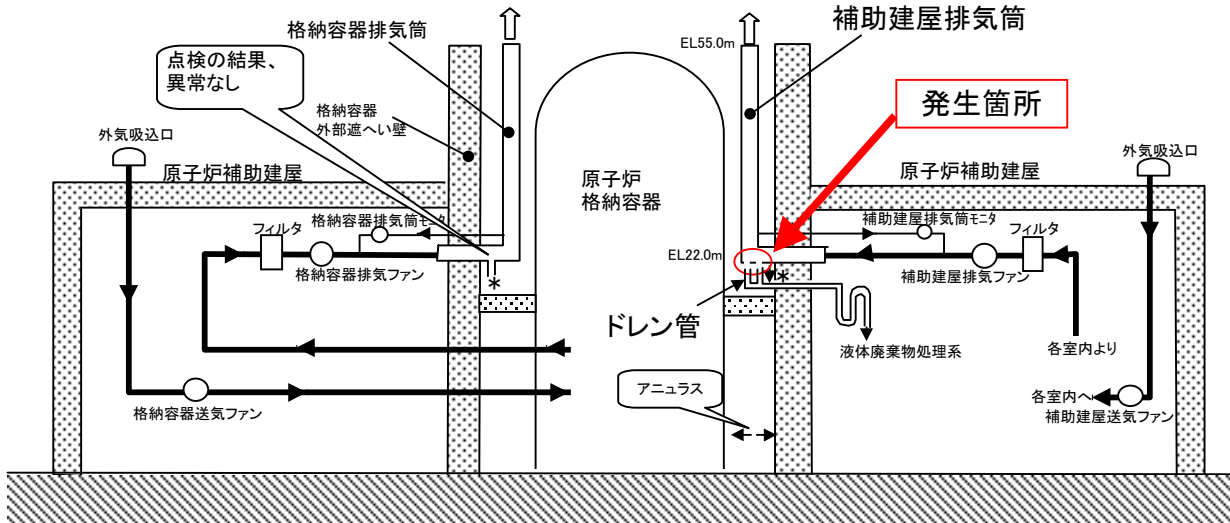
(1) 補助建屋排気筒のひび割れおよびドレン管の接続不良の原因と対策について
